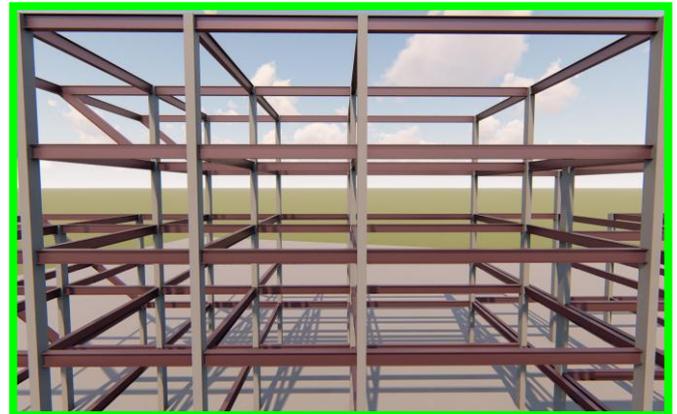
Articolazione colonna in cemento armato con trave metallica
